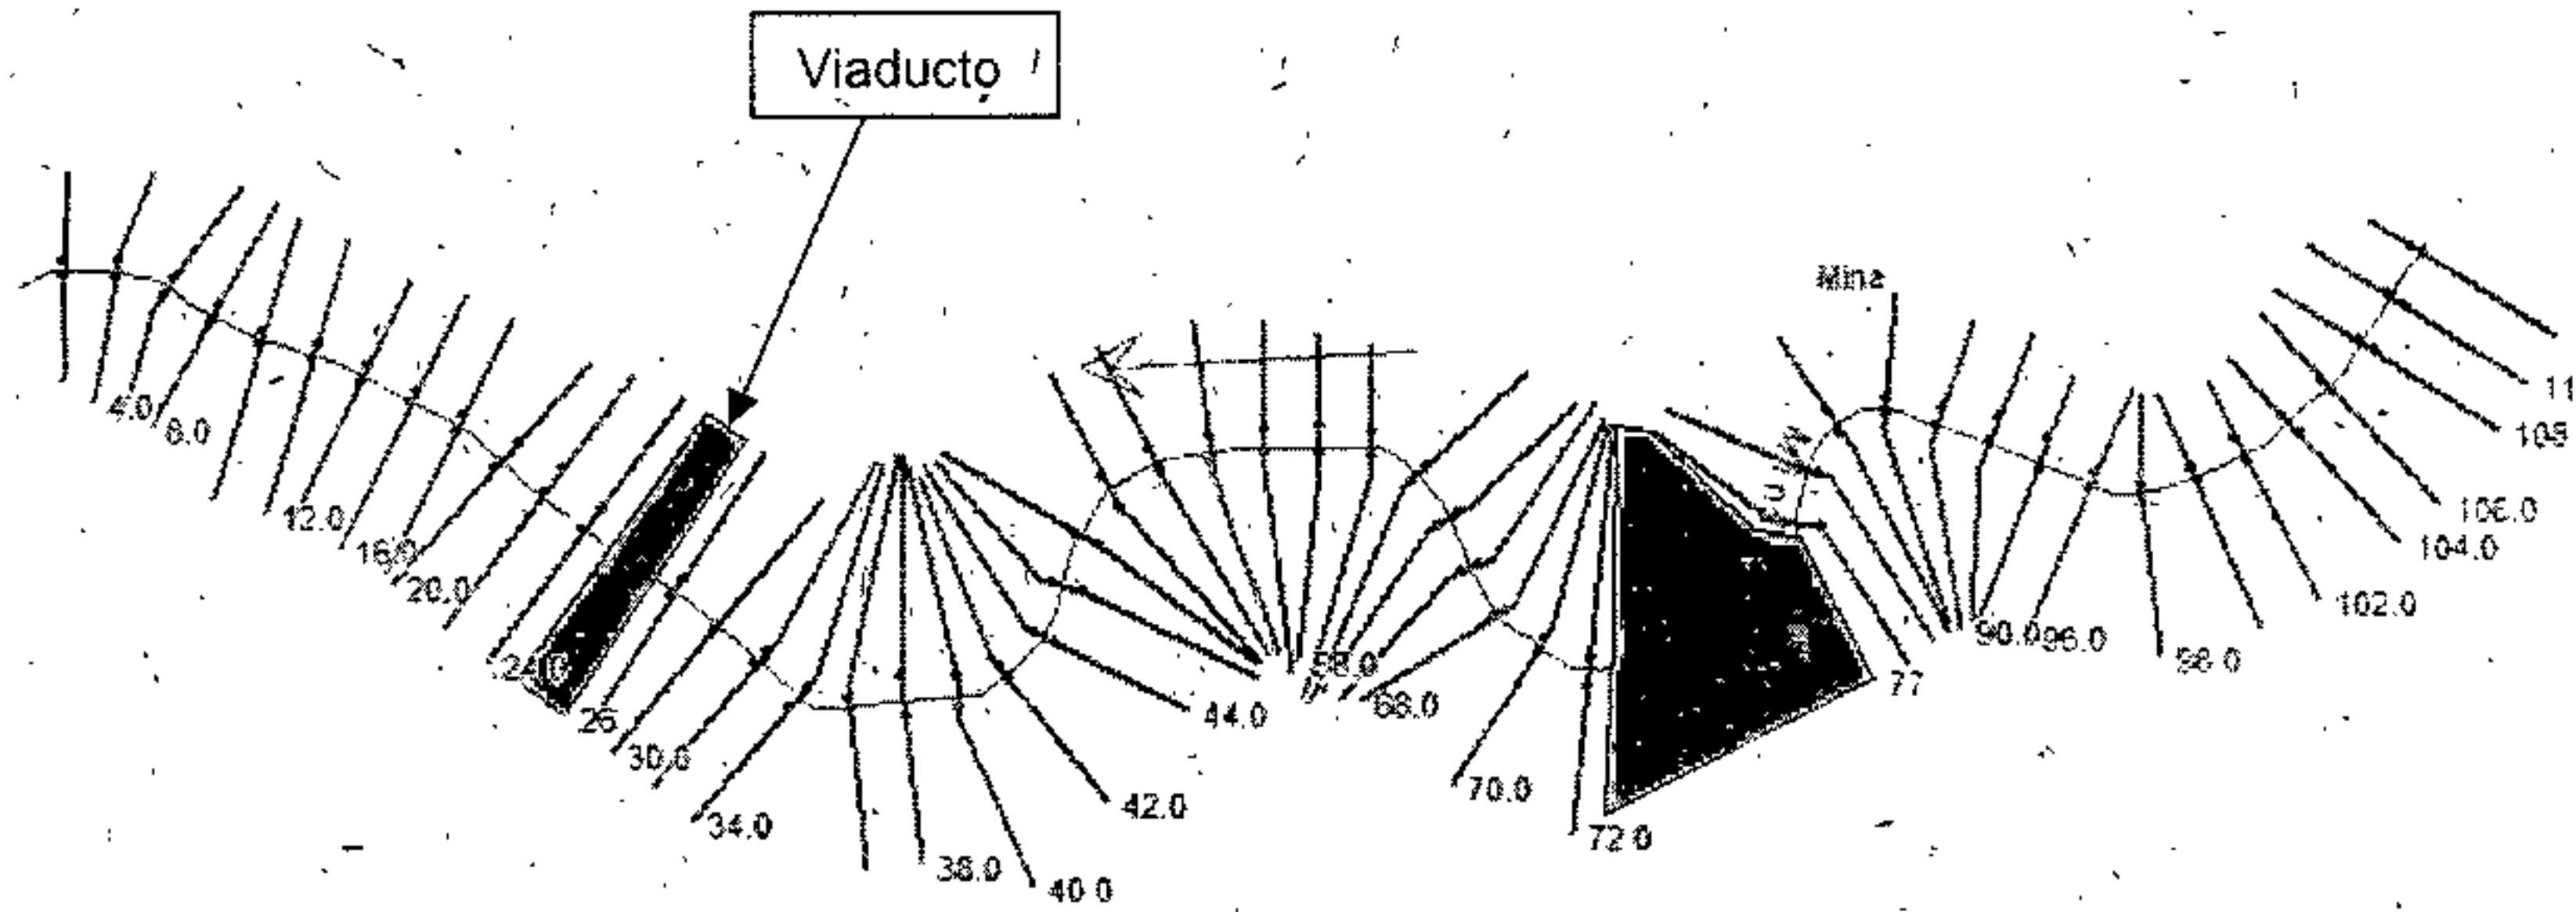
Ubicación en planta de secciones transversales y localización de obras existentes y proyectadas.
